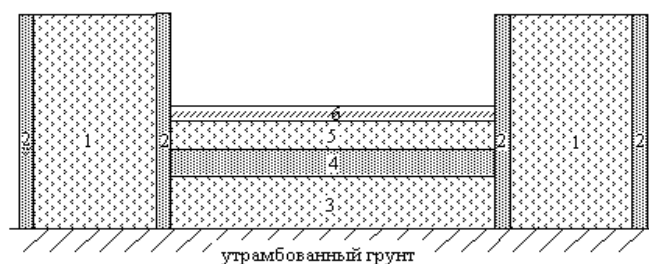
Конструкция пола и фундамента-стены подвального этажа
